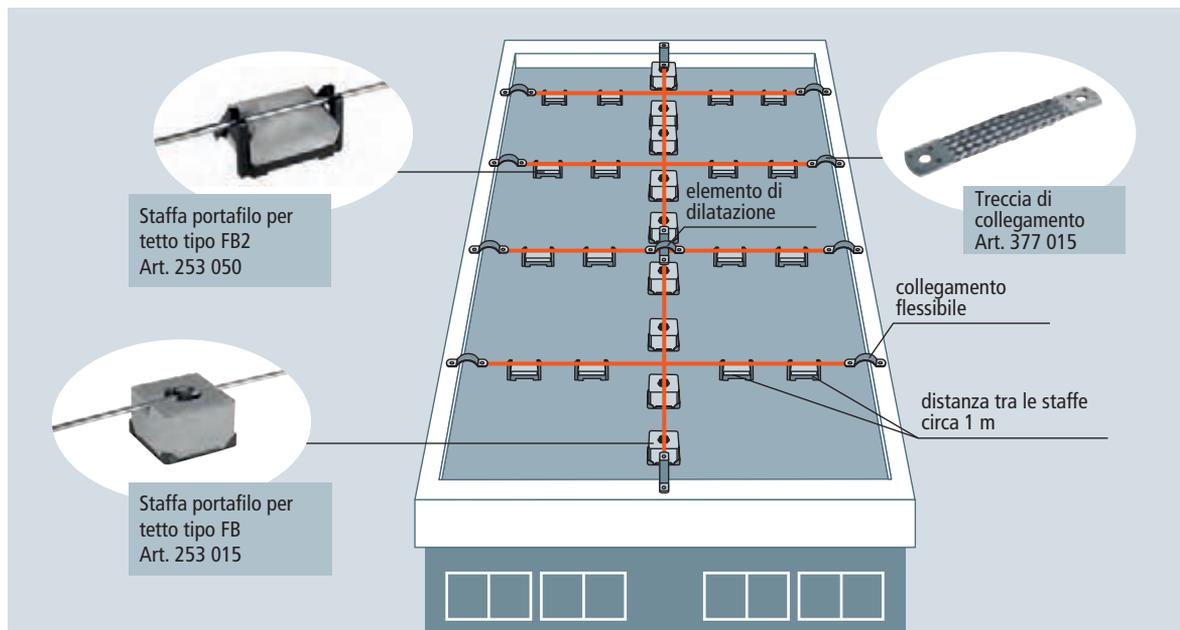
Dispositivo di captazione su un tetto piano
